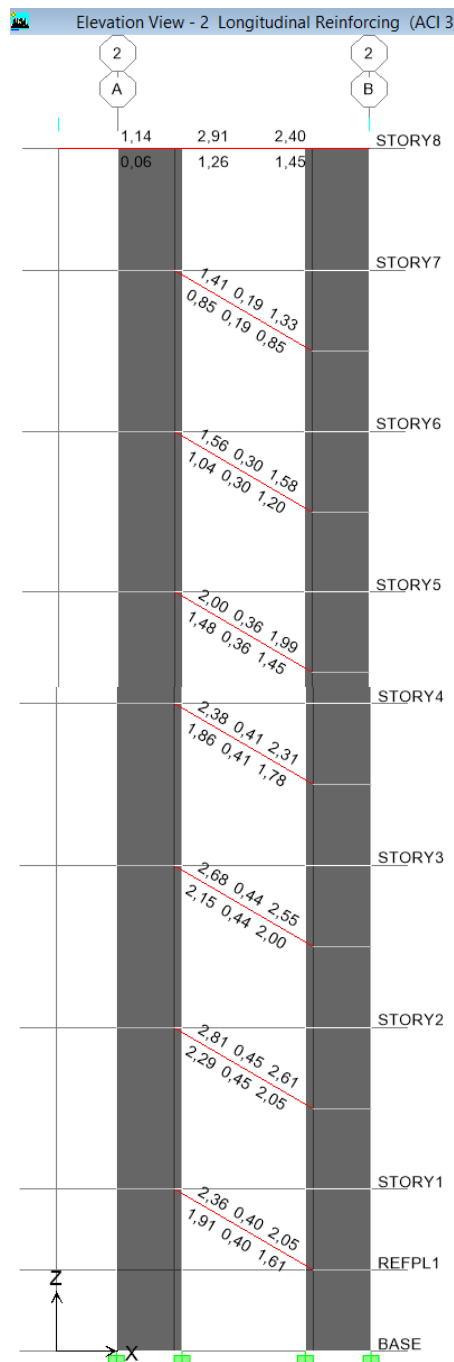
Acero en Vigas y Columnas en el Pórtico 2 – Escaleras de Emergencia Hospitalización 2- (NEC-11)
